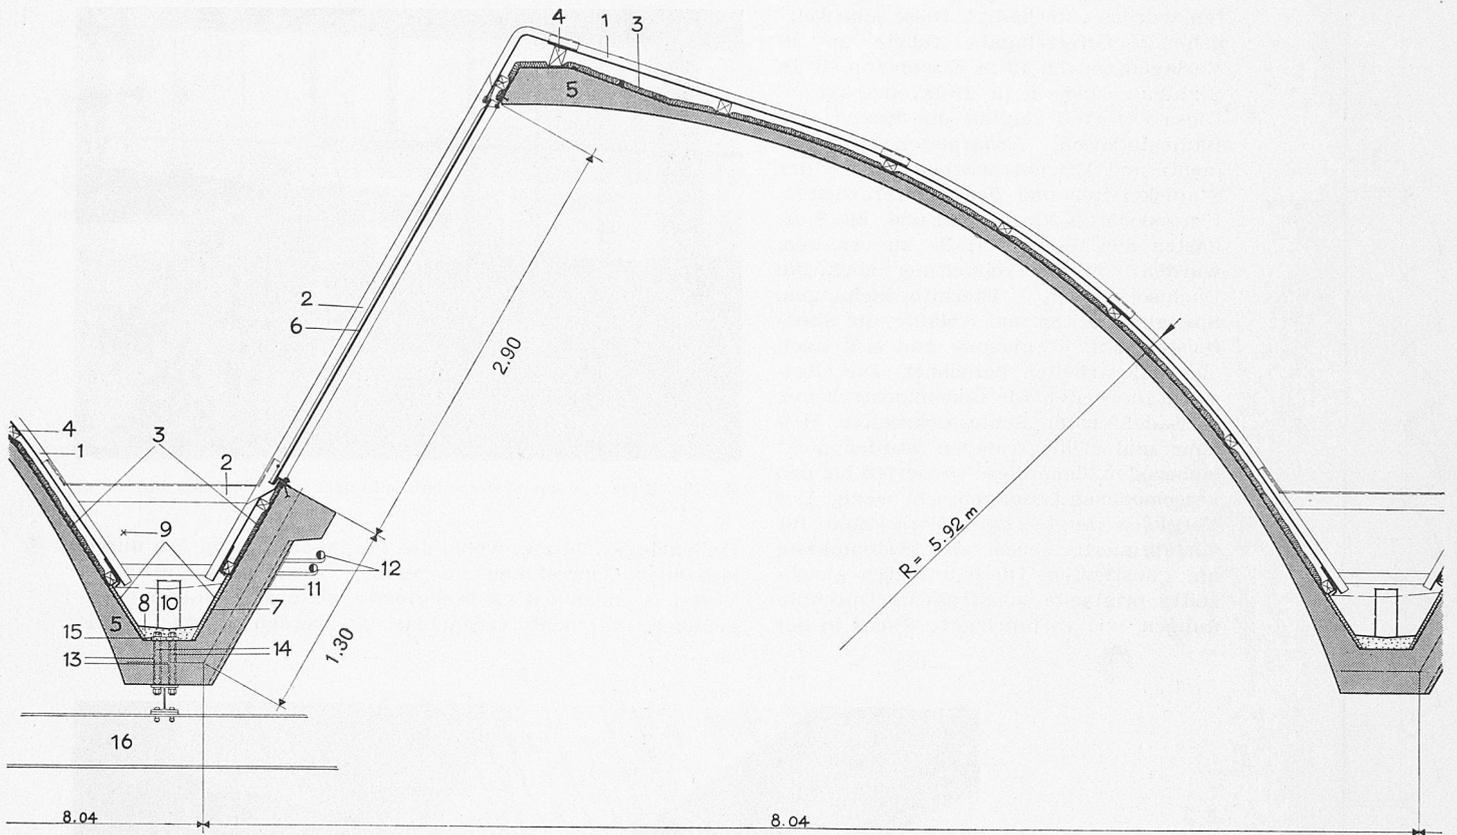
Eisenbetonschalenshed, Hallen-Längsschnitt 1:50, Legende siehe nächste Seite
